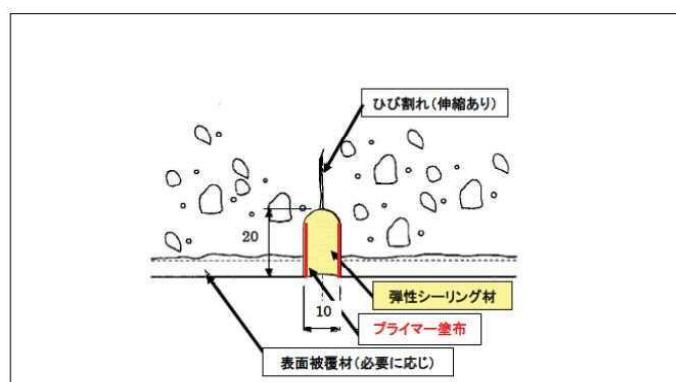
ひび割れ充てん工法概要図
